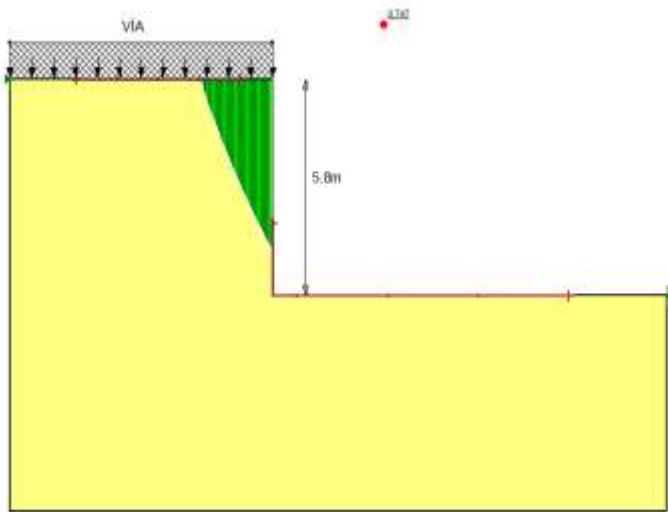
Modelos de estabilidad para excavación por medio de corte vertical (Estático) – Puerto Madero
